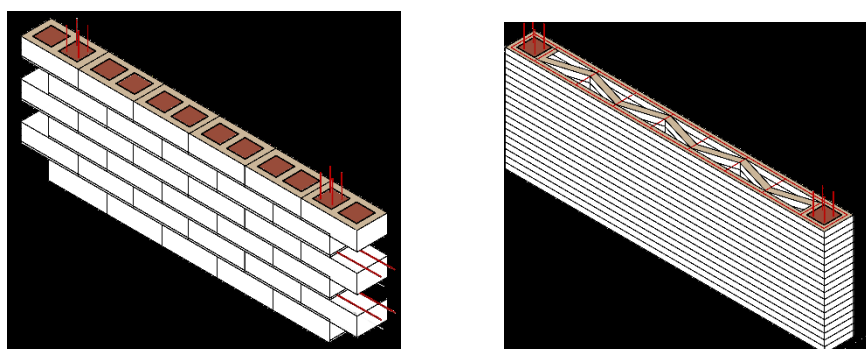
Analogia tra parete in muratura e parete stampata 3D.
